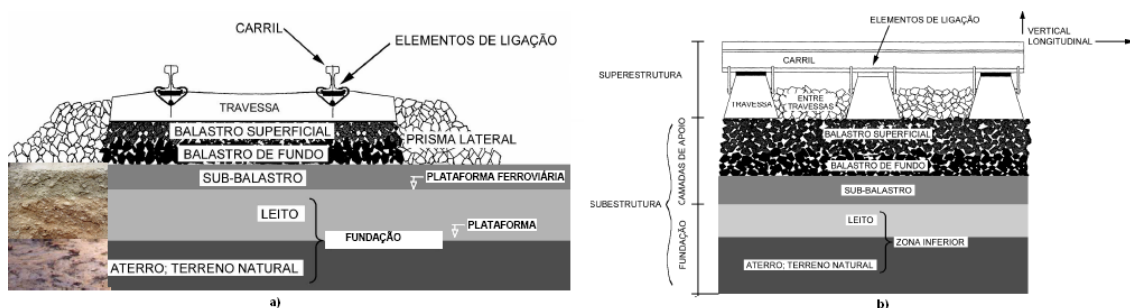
Estrutura da via férrea: a) corte transversal; b) corte longitudinal (Fortunato, 2006)
